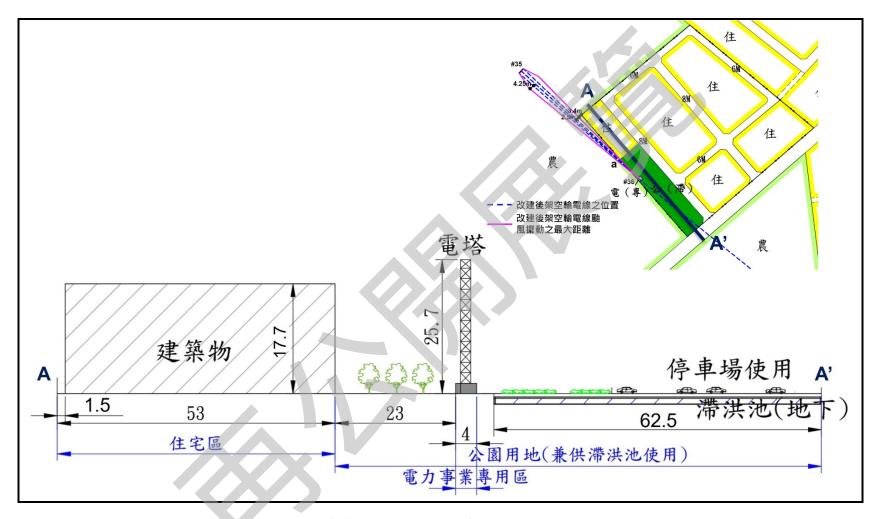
公園用地 (兼供滯洪池使用) 規劃平面與剖面示意圖
